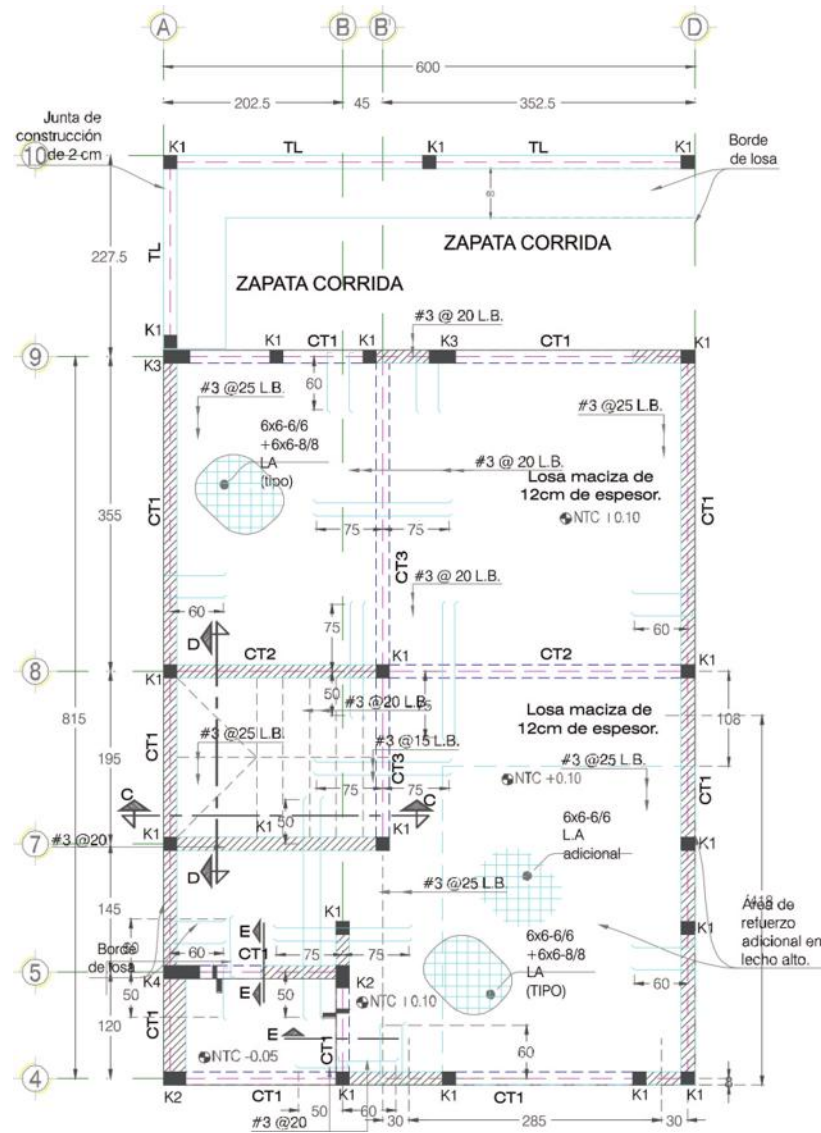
PLANTA DE CIMENTACIÓN (ROBLE).// IMAGEN: PLANO ESTRUCTURAL ROBLE, TRES MARIAS.
